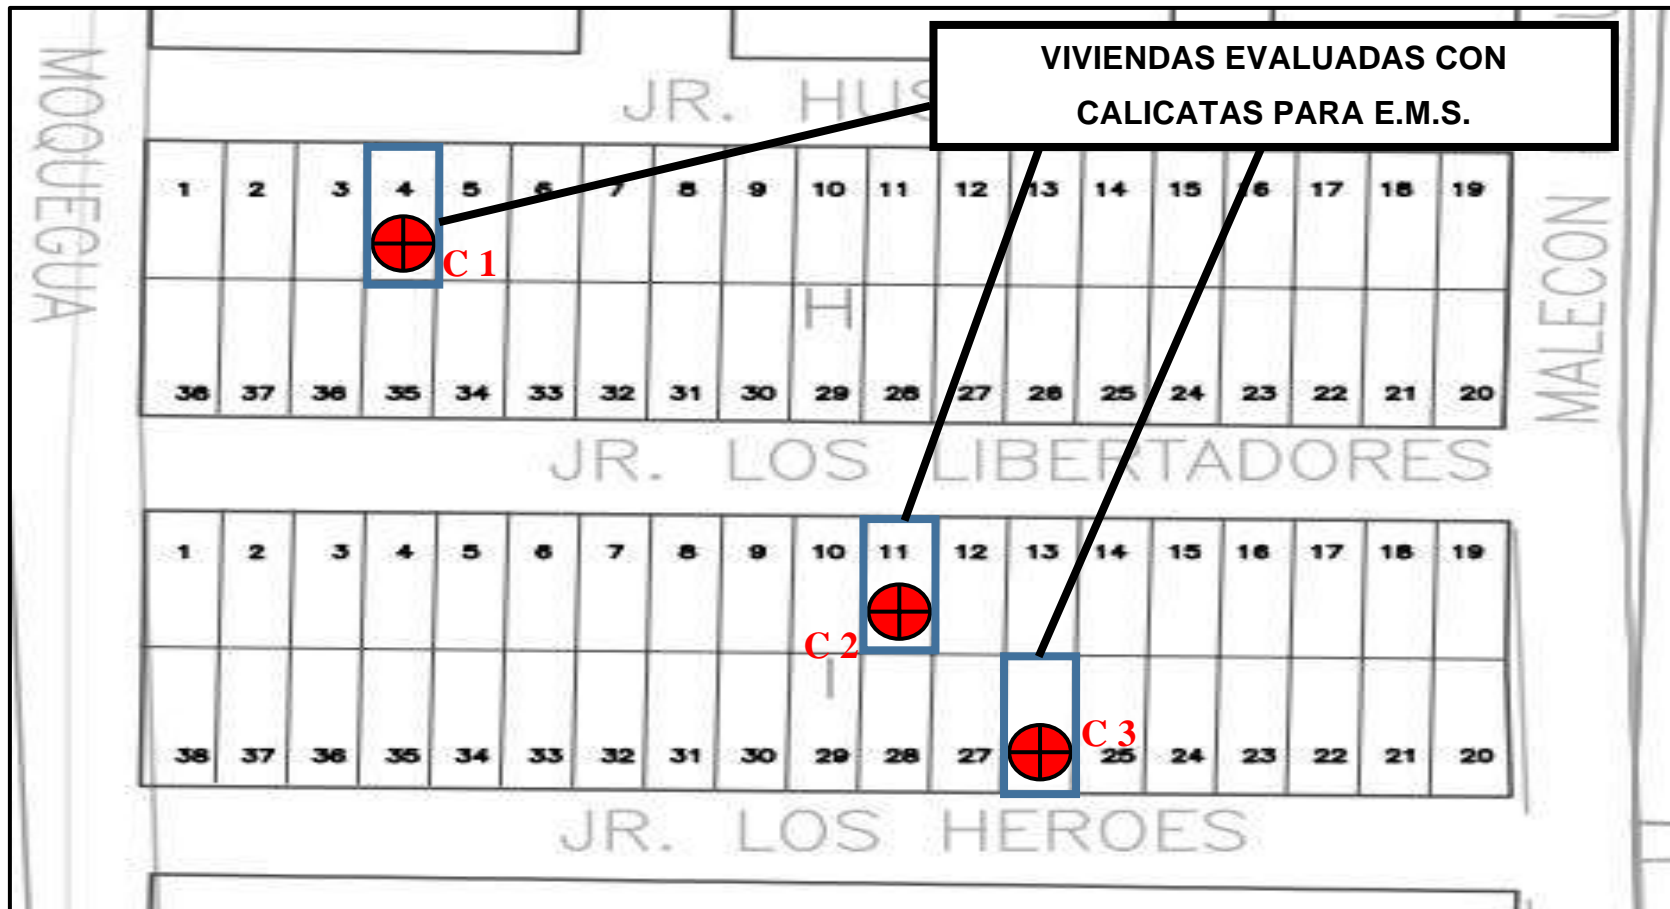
Plano de ubicación de viviendas evaluadas con calicatas para E.M.S.
